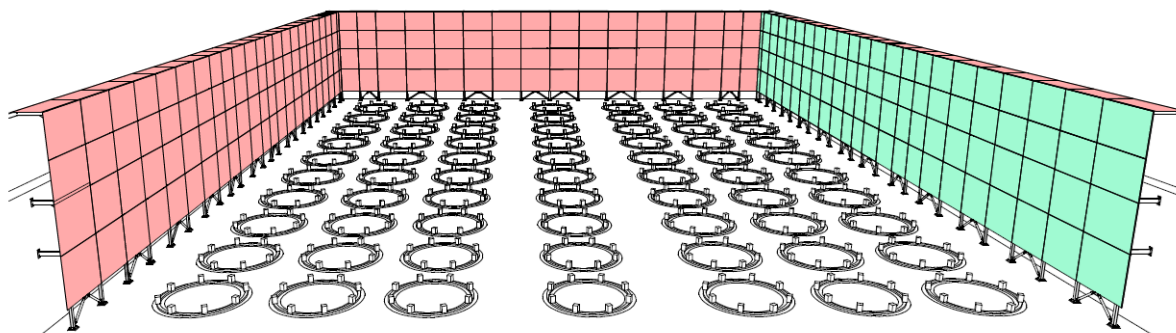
Sidrenje čelične konstrukcije u betonske konzolne zidove
